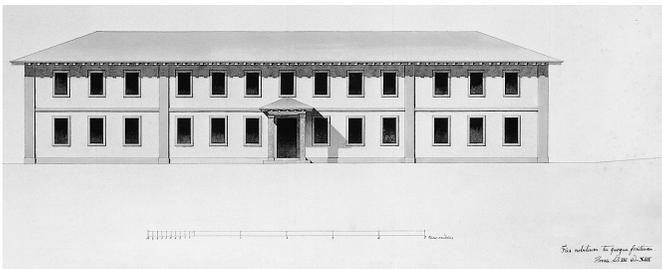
Lavey, projet de concours pour les bains d'Henri Fraisse, élévation de la façade d'entrée, 1835 (ACV).
